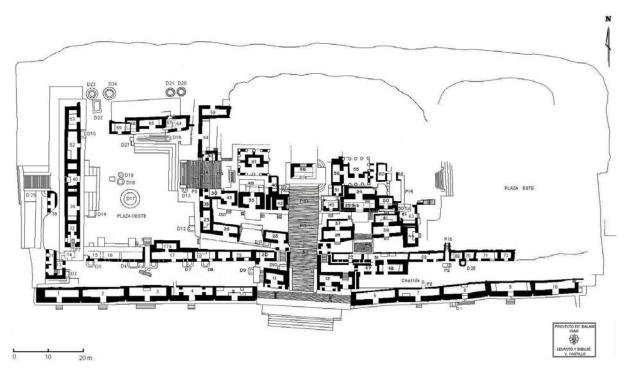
PLANTA ARQUITECTÓNICA DE LA ACRÓPOLIS O ESTRUCTURA 1.
